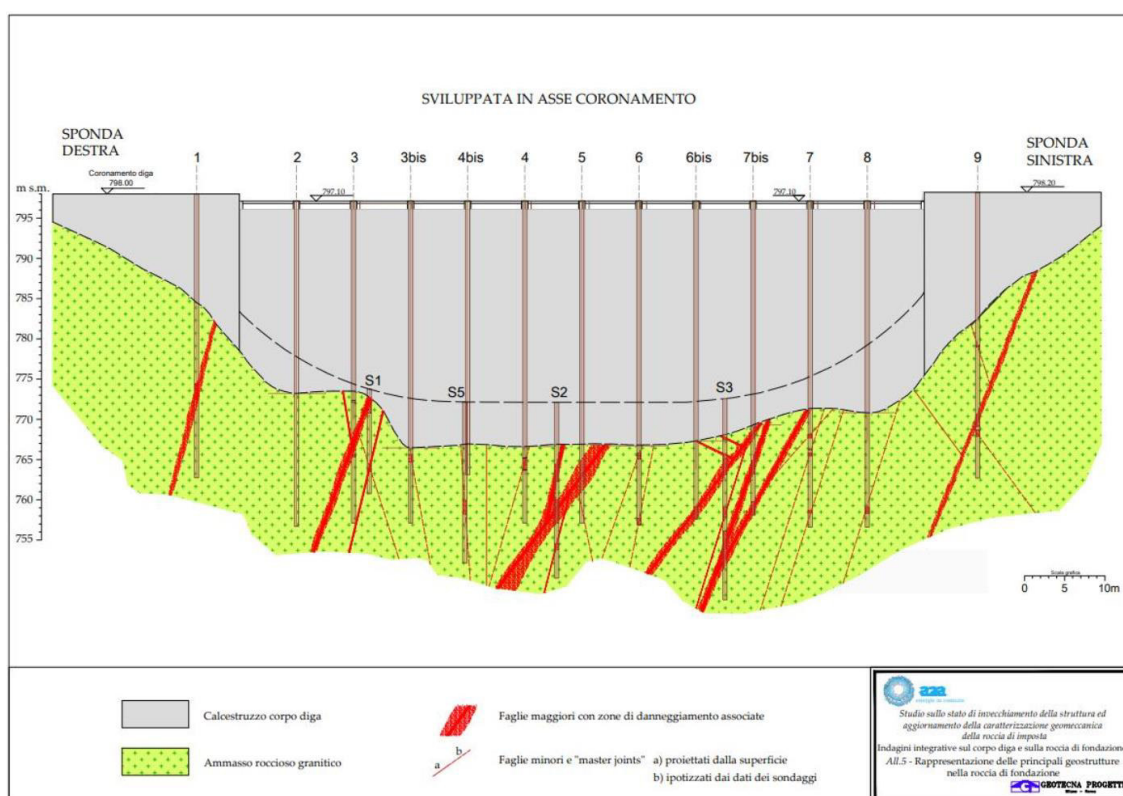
Sezione geostrutturale in asse diga (GEOTECNA, 2011).
